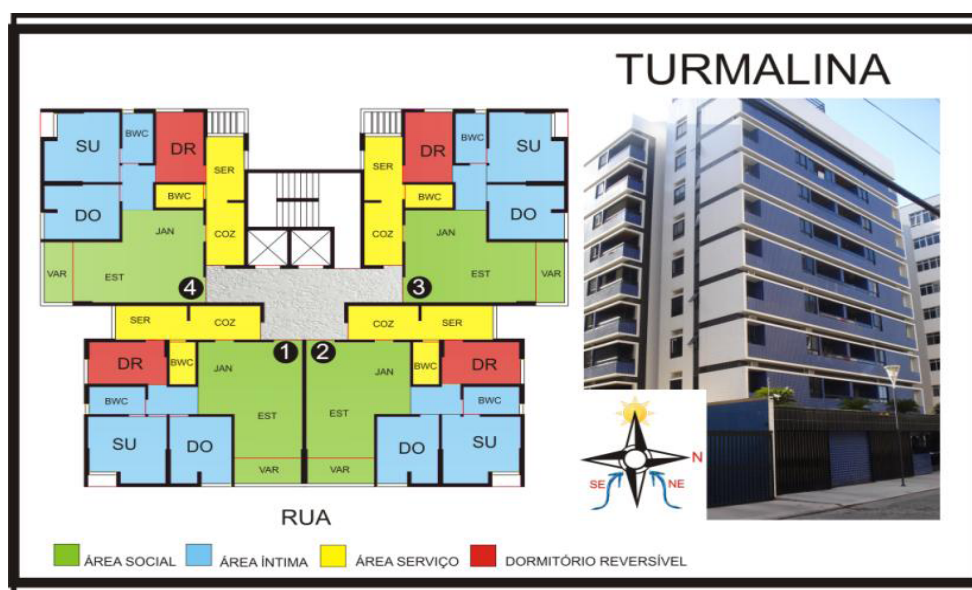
Planta baixa setorizada e foto da fachada do edifício.
